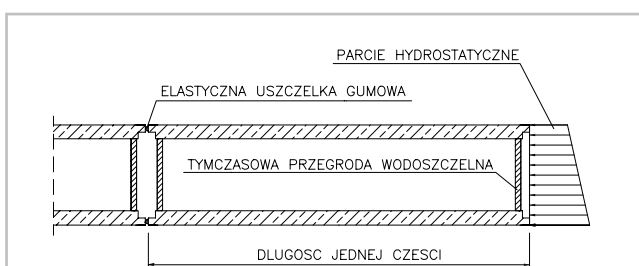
Przykładowy przekrój poprzeczny tunelu stalowego
